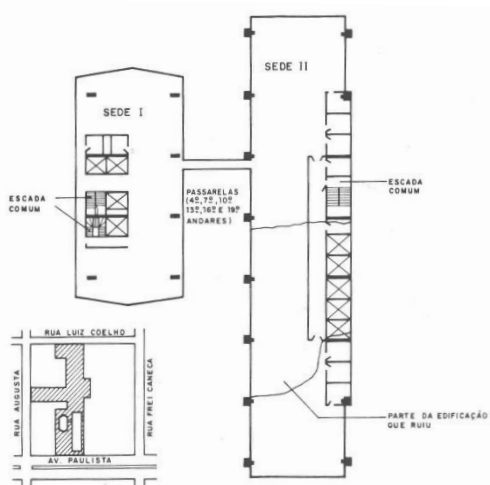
Plan esquemático del tipo de pavimento de los edificios Sede I y Sede II de CESP, que muestra el sector que colapsó
